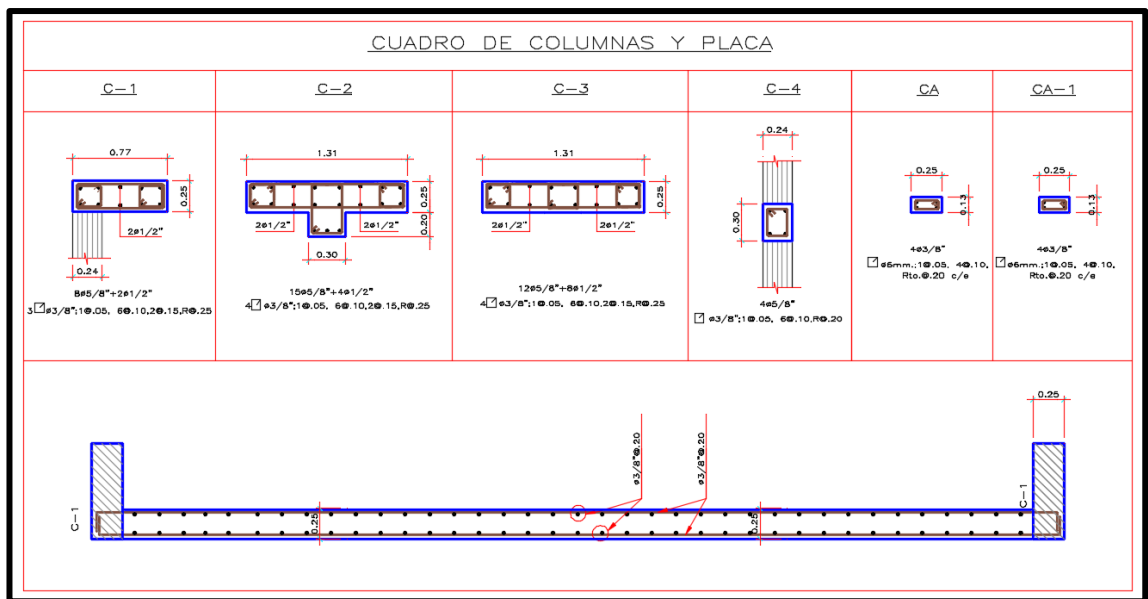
Geometría y Cuantía de Acero en Elementos Estructurales para Columnas y Placas.
